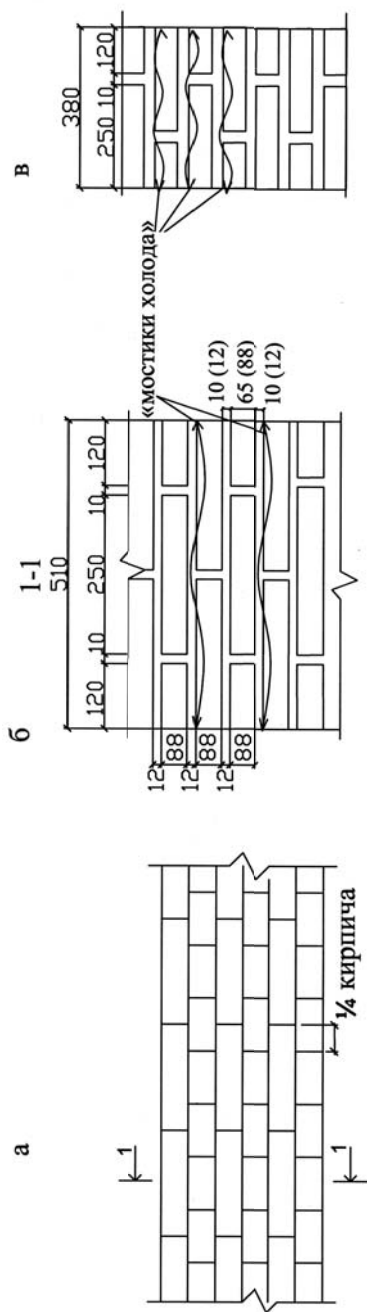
Однорядная цепная перевязка (из кирпича толщиной 65 мм) кладки стен (а)
